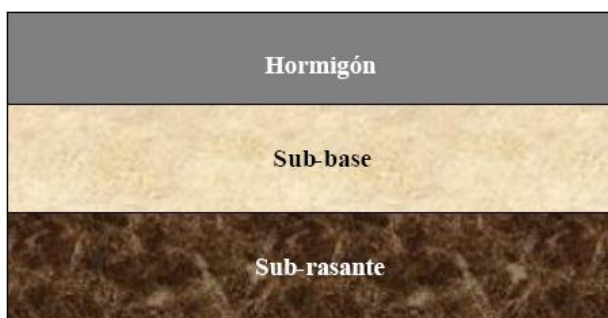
Elementos que Integran el Pavimento Rígido
